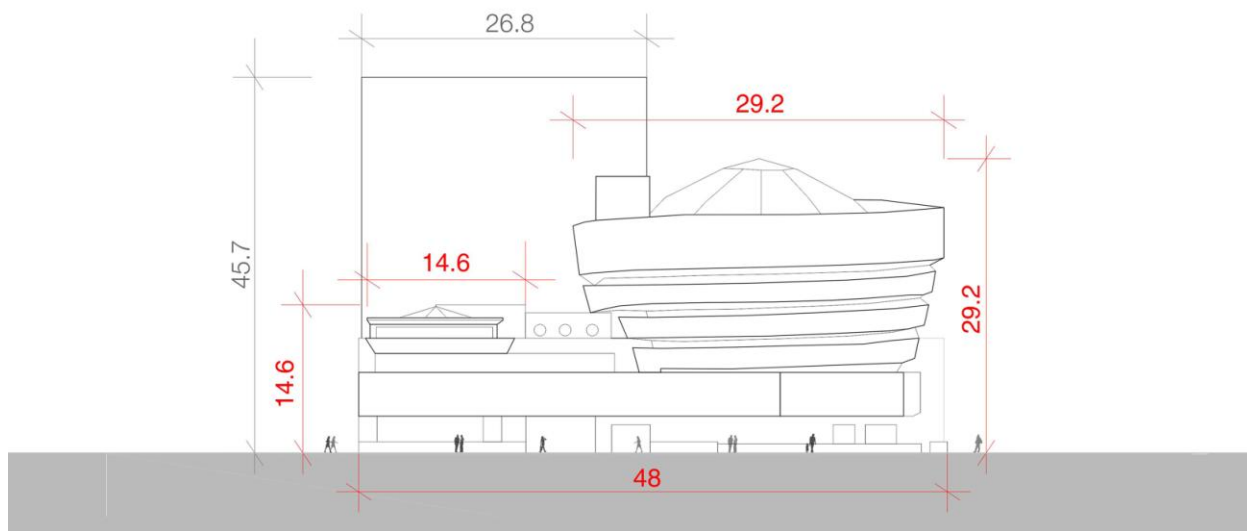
| Fachada Museu Guggenheim, com dimensões | re-desenho da autora
